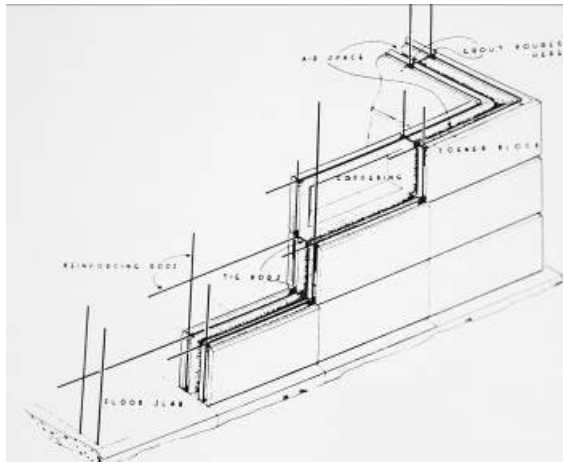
Axonométrica tipo muro cerramiento perimetral.
